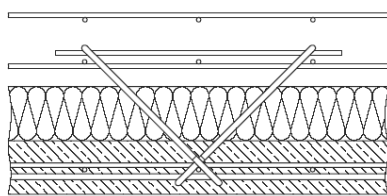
Obere Schicht bewehren, SPA-1 /-2 entsprechend Anlage 4 einflochten (siehe auch Bilder 1 - 4). Einhalten der Ankerlänge im Beton gemäß Anlagen 4 und 5.
